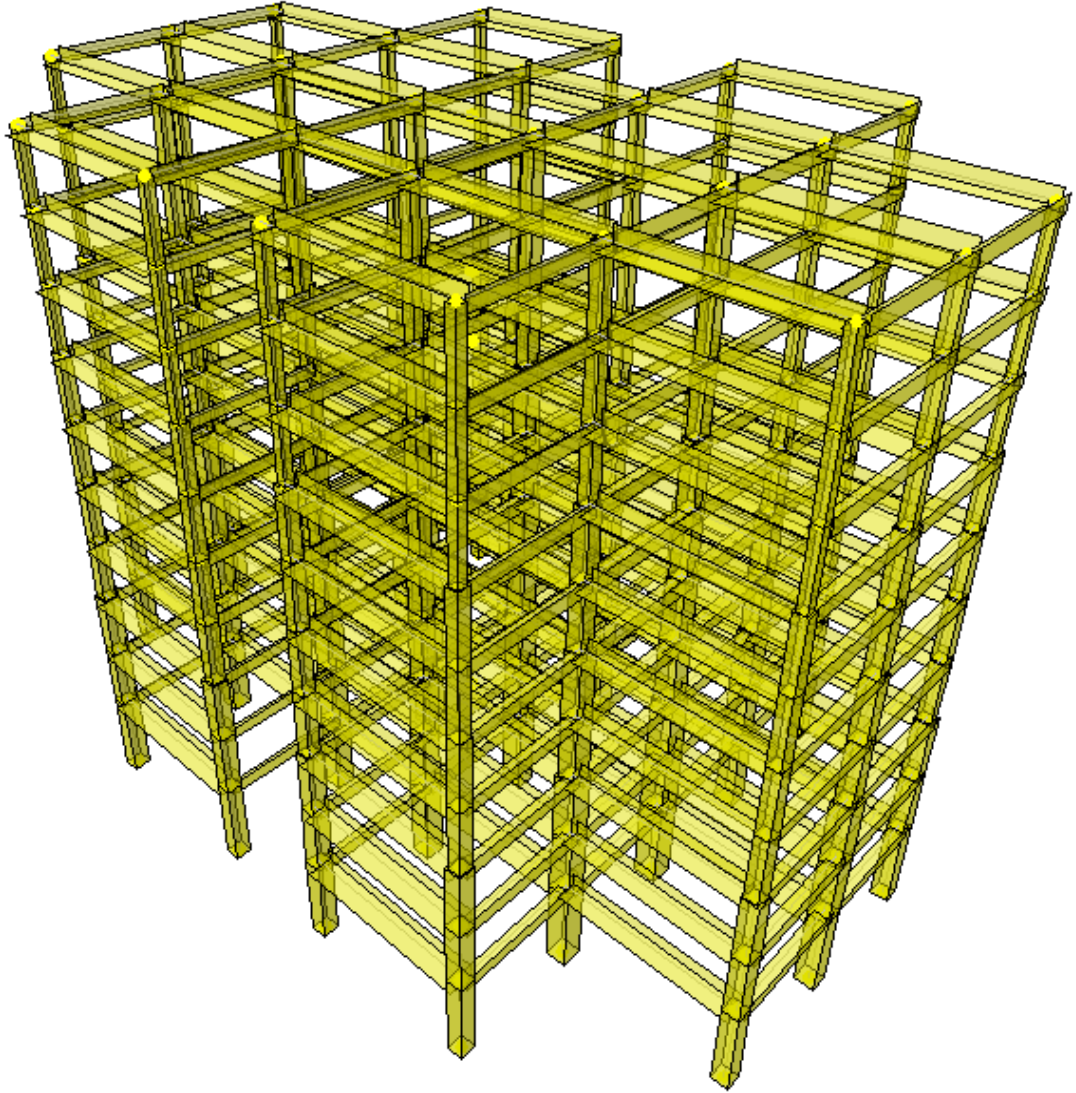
'te kat planı verilen 10 katlı B/A yapının boyutlandırılması yapılmıştır.
